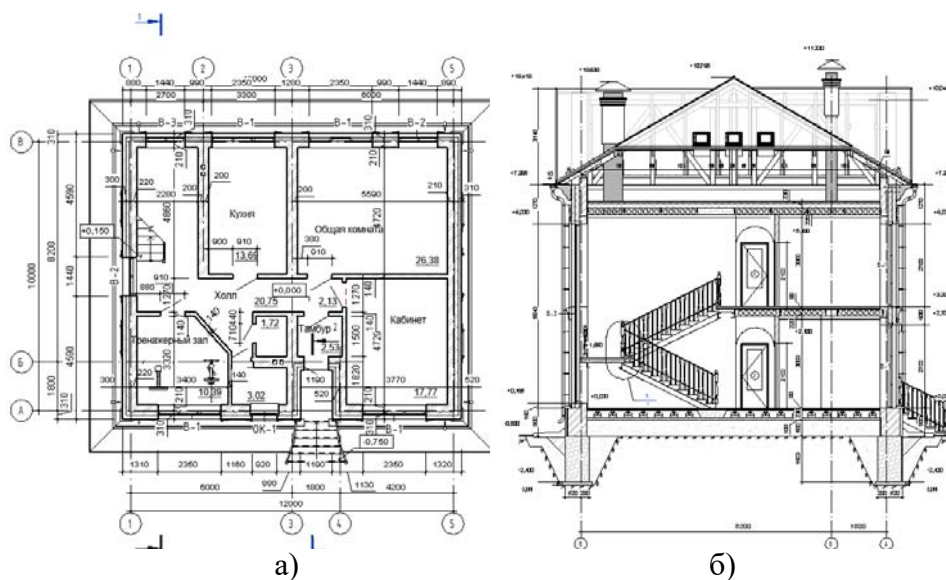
План этажа и разрез жилого дома (вариант 1):
